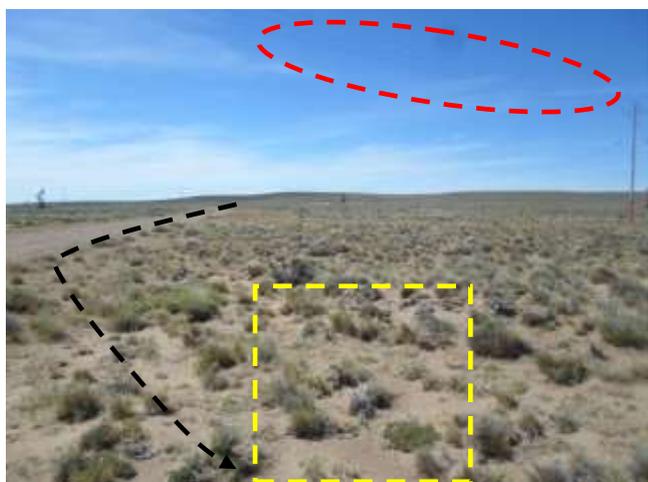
Fin de Emplazamiento de acueducto en futuro satélite de inyección EN 3 (amarillo). Cruce con línea eléctrica. (rojo)
